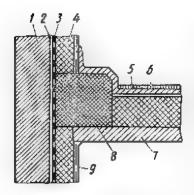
Примыкание междуэтажных перекрытий к наружным стенам:
